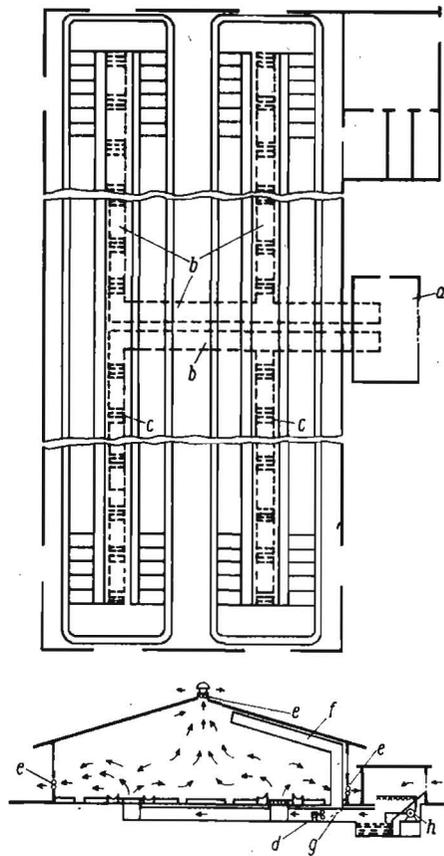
Grundriß und Querschnitt des Kuhstalles vom Typ K 250 DK
